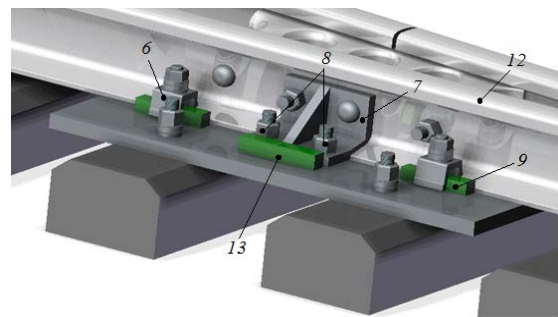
Кореневе скріплення вкладишно-накладочного типу СД (вид із польової сторони колії)
